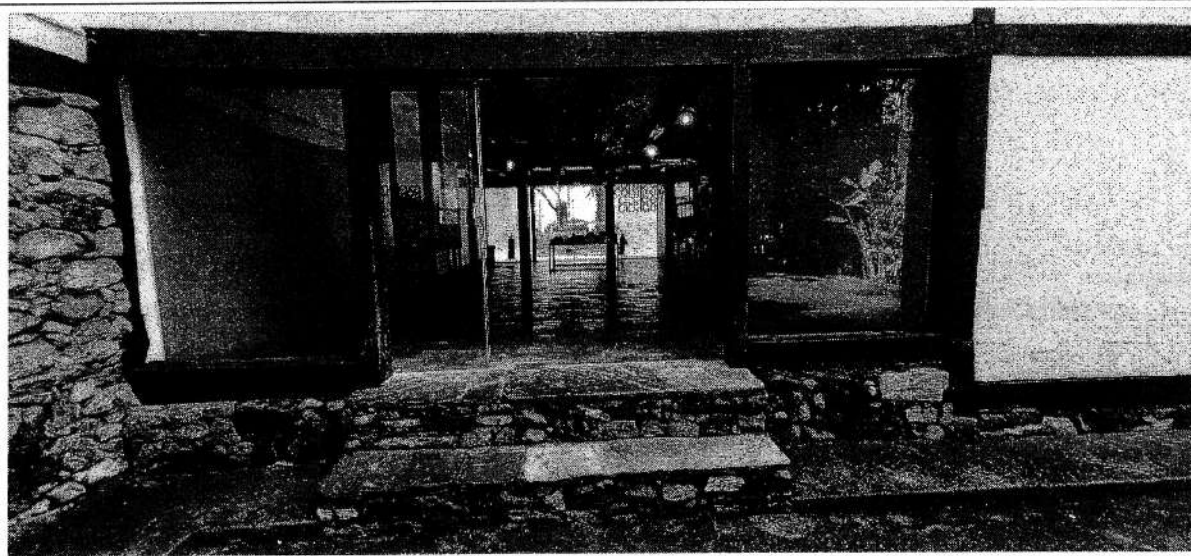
Casarão – térreo – circulação área interna/externa próximo aos sanitários coletivos (não acessíveis)
